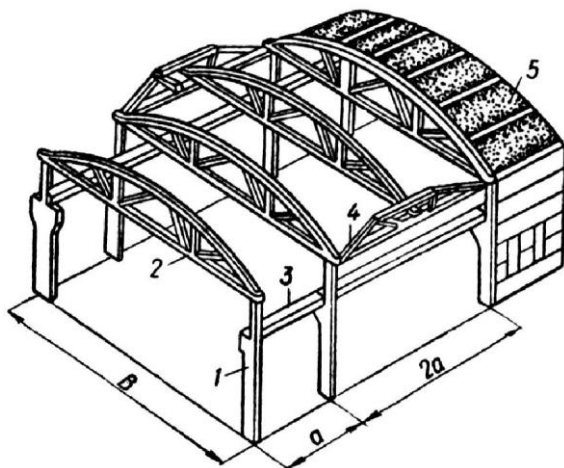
Каркас одноповерхової будівлі (залізобетонний):
